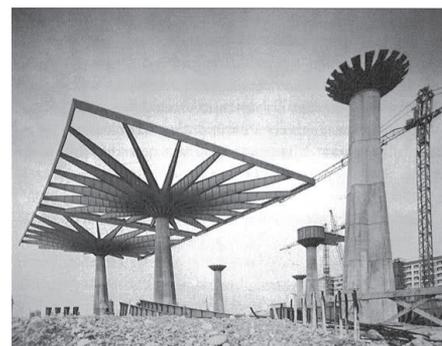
Errichtung eines Bauelements, Palazzo del Lavoro
